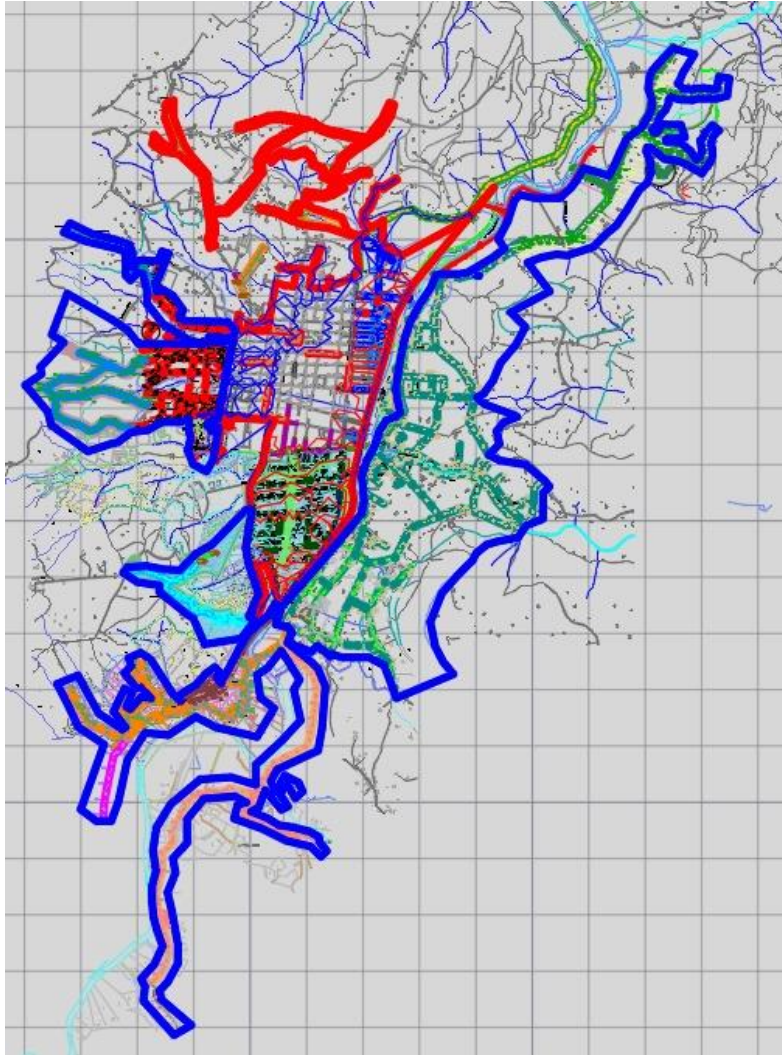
Áreas de aporte tomadas en cuenta para el caudal de infiltración
